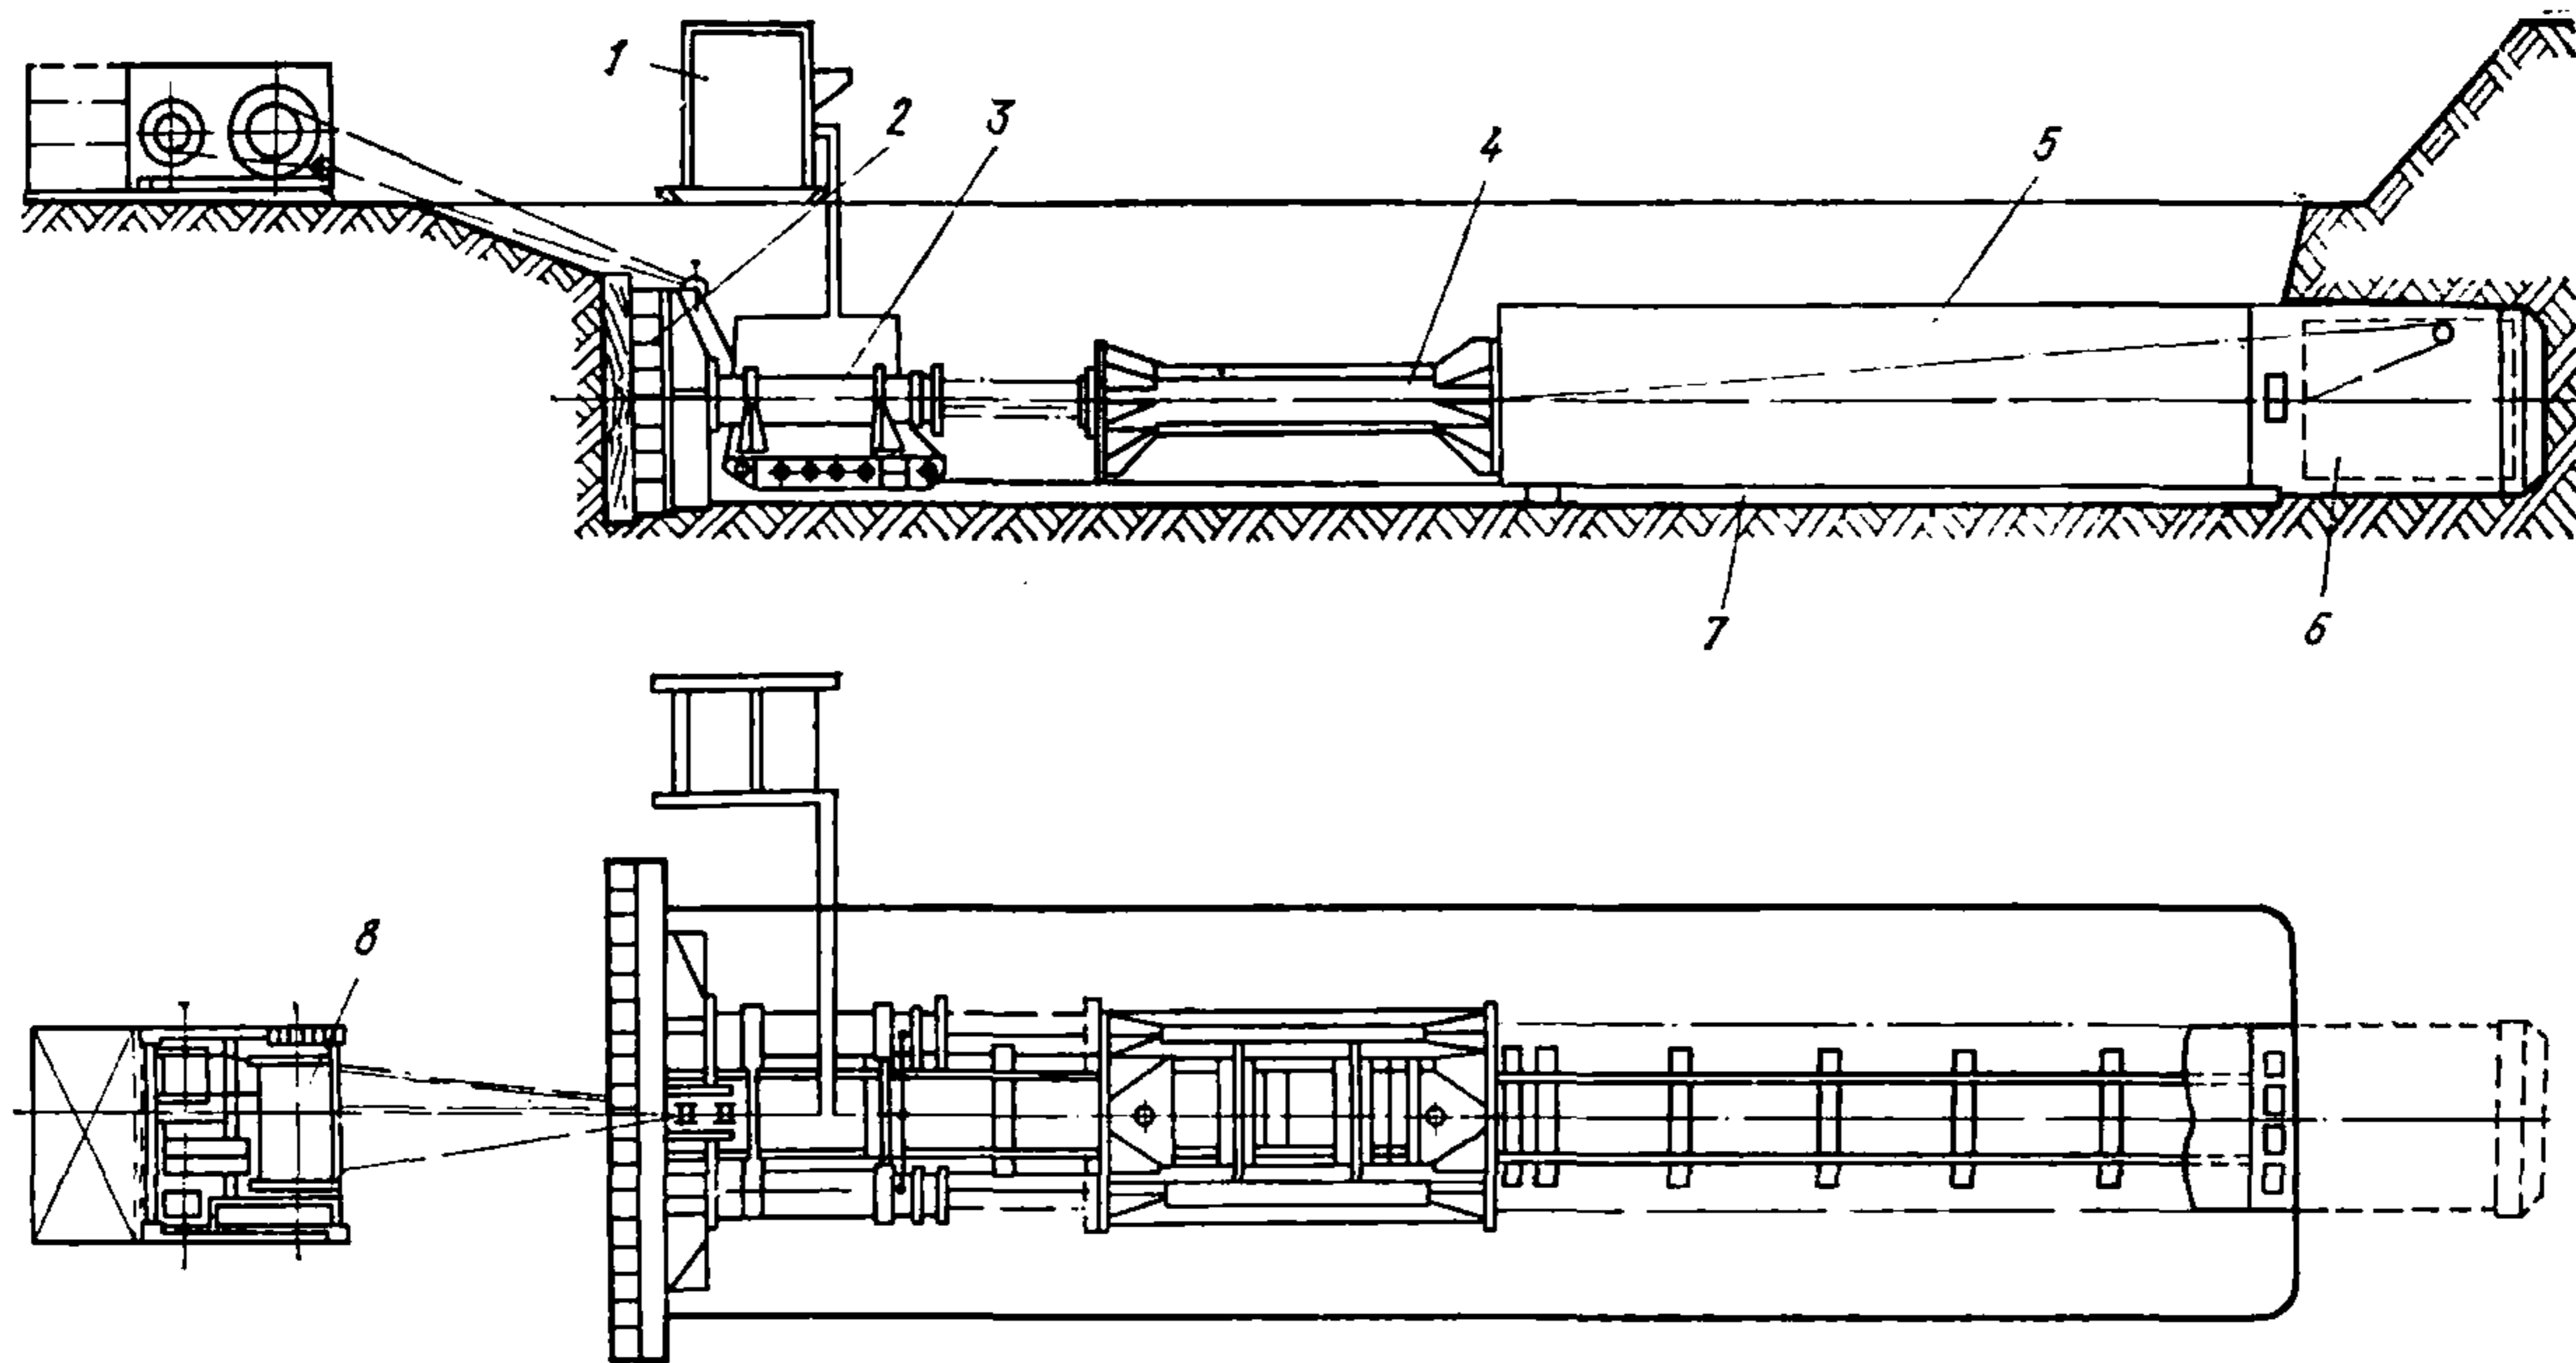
Установка для бестраншейной прокладки труб У-12/60
